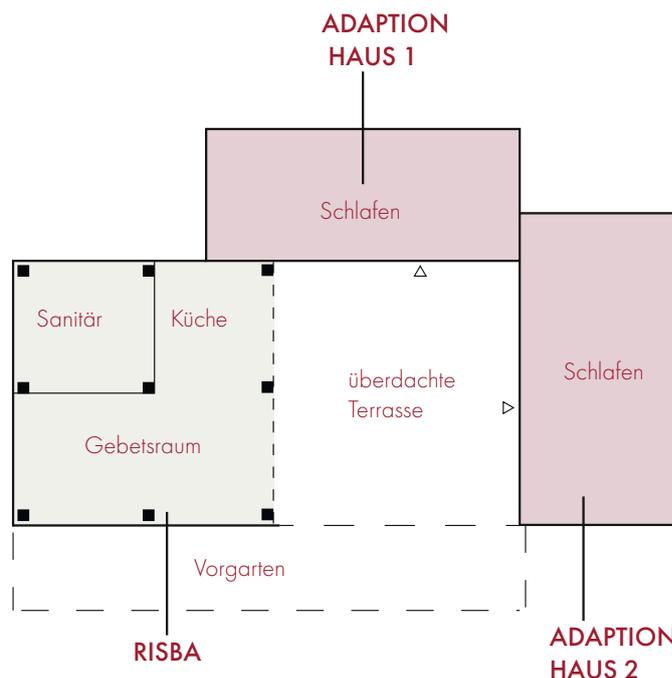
Firhans Haus Grundriss: in grau Wiederaufbautyp RISBA und in rot die zwei adaptierten Häuser
